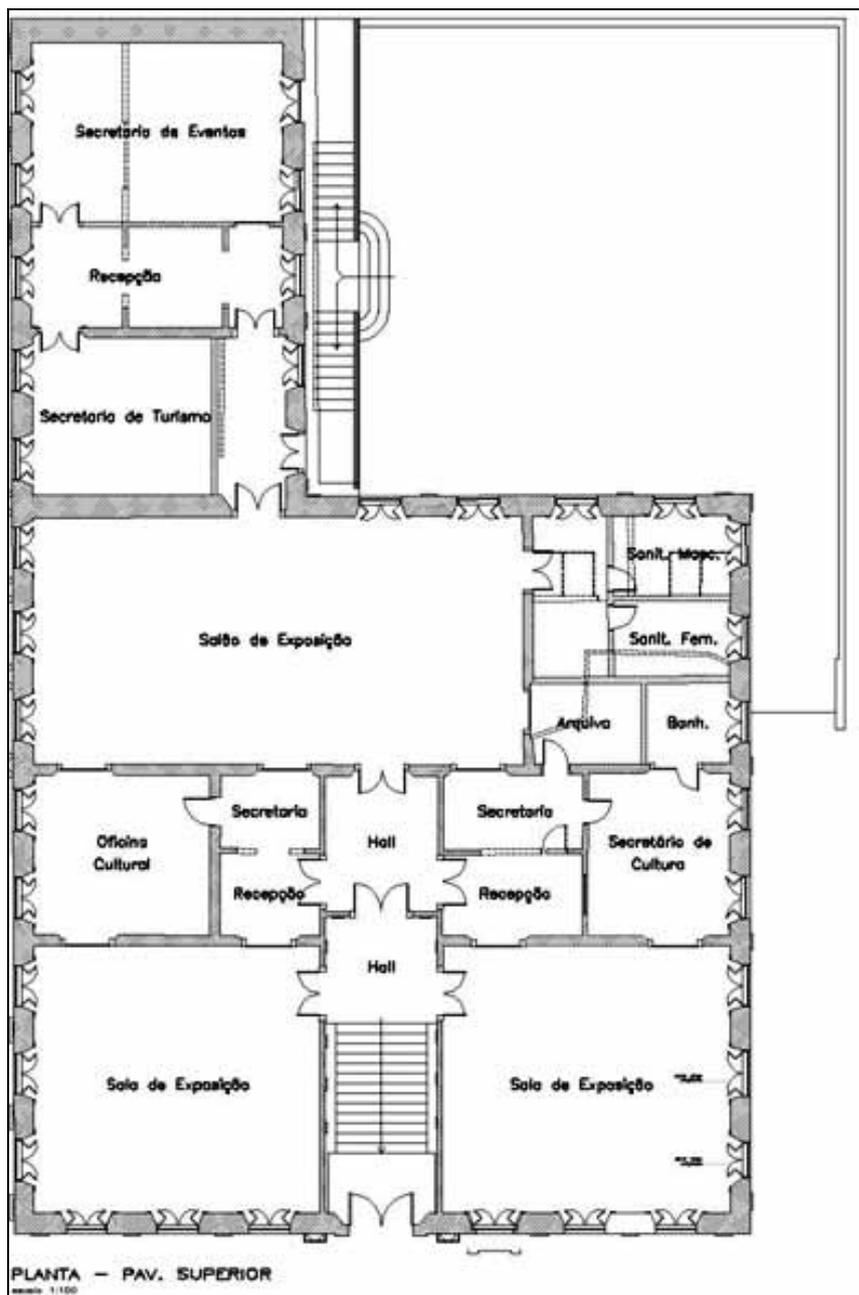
Planta digitalizada do pavimento superior do Palacete Levy.
